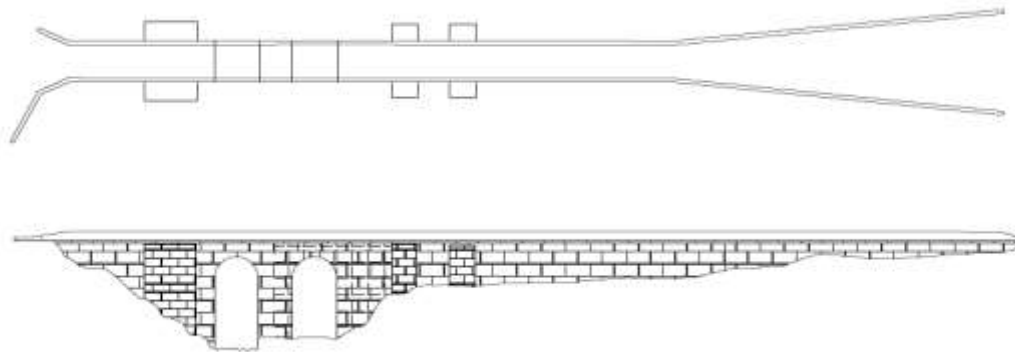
Plano de Planta y perfil, Puente Chipilapa Jalapa.
